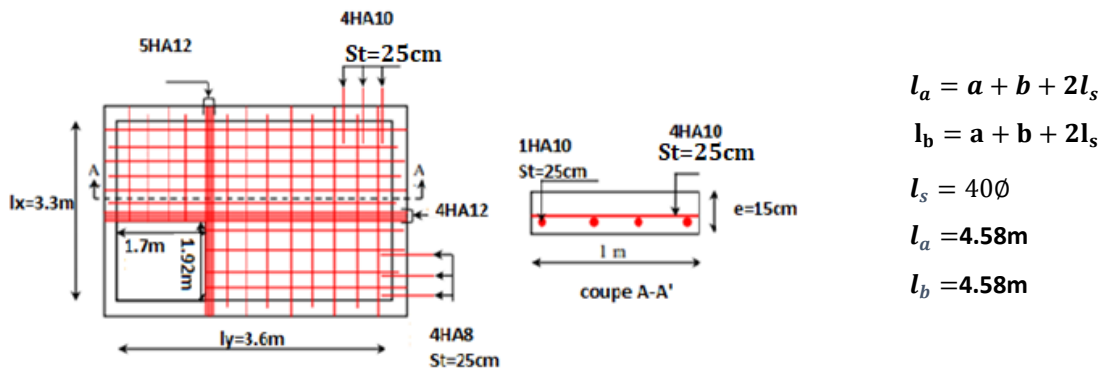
Schéma de ferrailage de dalle pleine (DP11).
